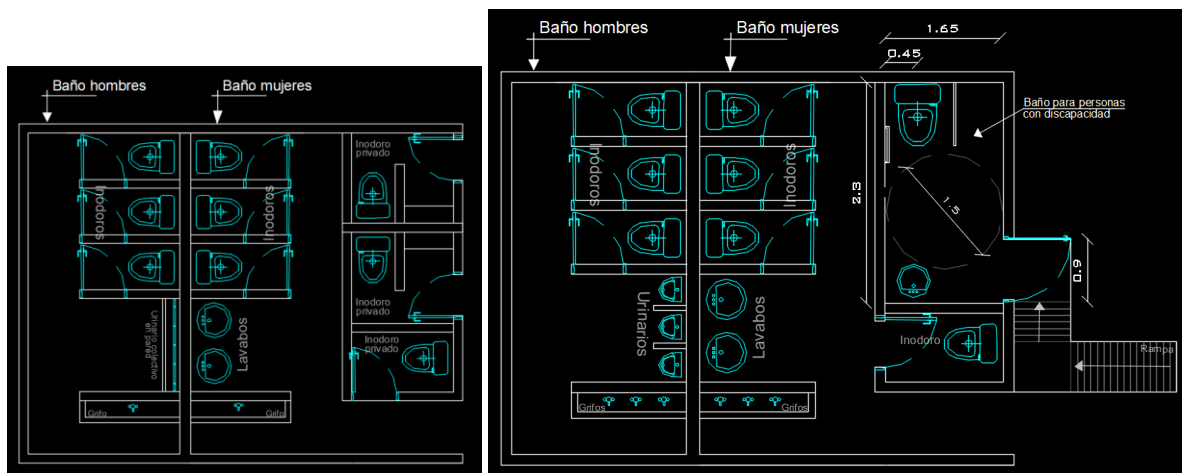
Plano arquitectónico actual y futuro de la batería central del bloque 4. Fuente: autoría propia
